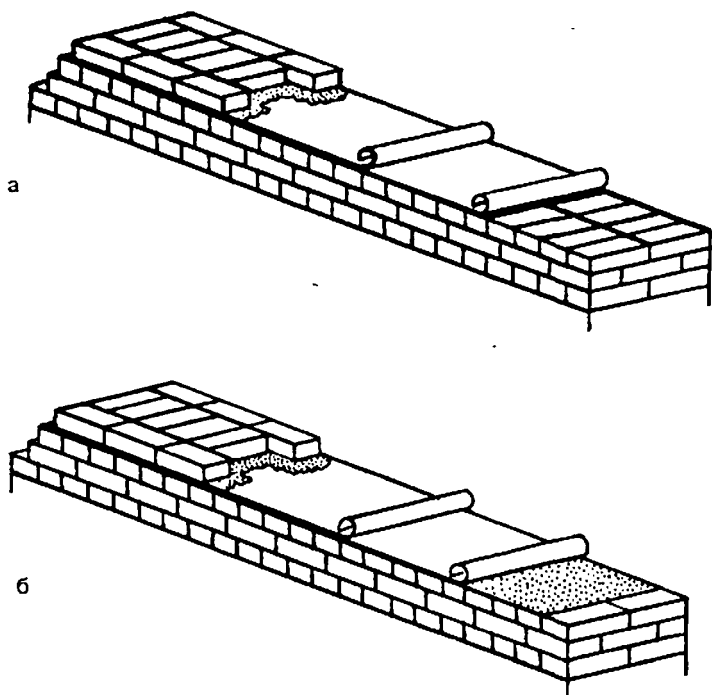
Горизонтальная гидроизоляция цоколя стен:
